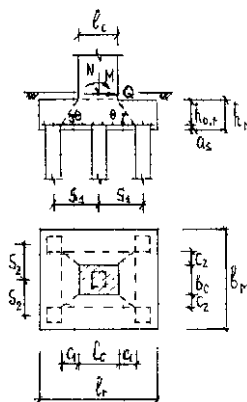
Схема образования пирамиды продавливания под монолитной железобетонной колонной
